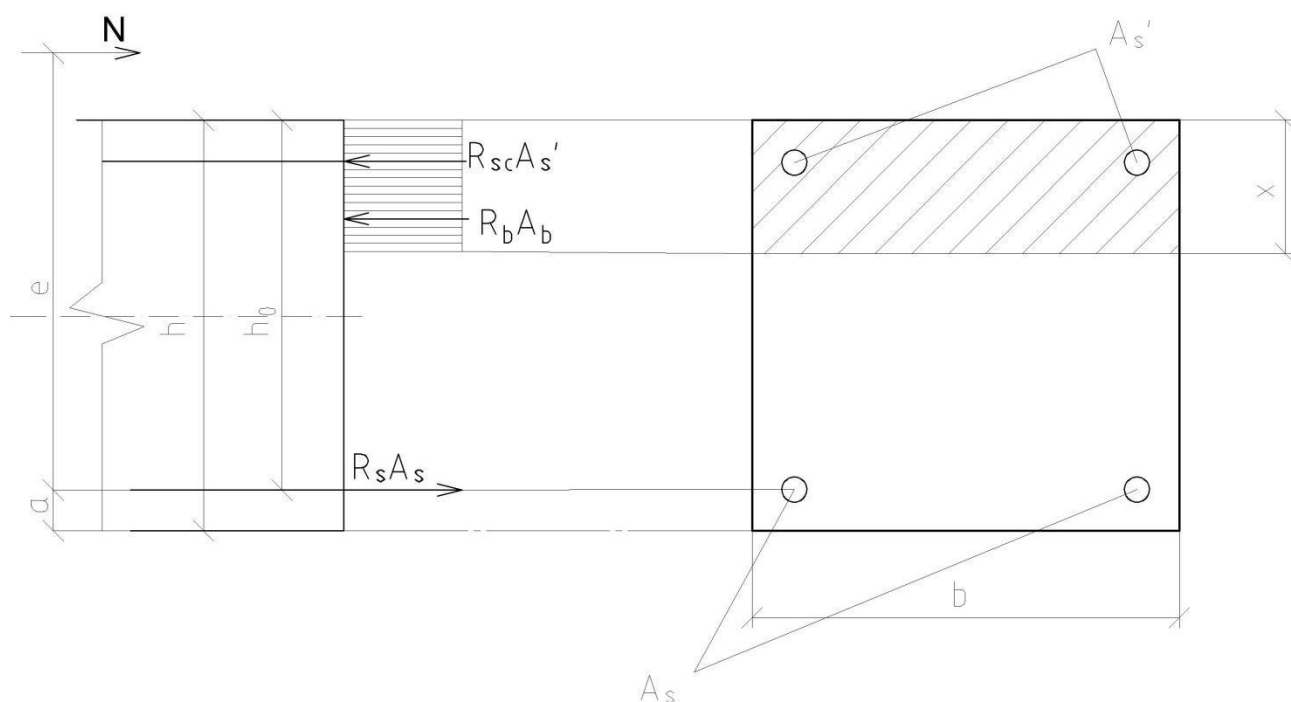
Схема усилий и эпюра напряжений в сечении, нормальном к продольной оси внецентренно сжатого железобетонного элемента, при расчете его прочности
